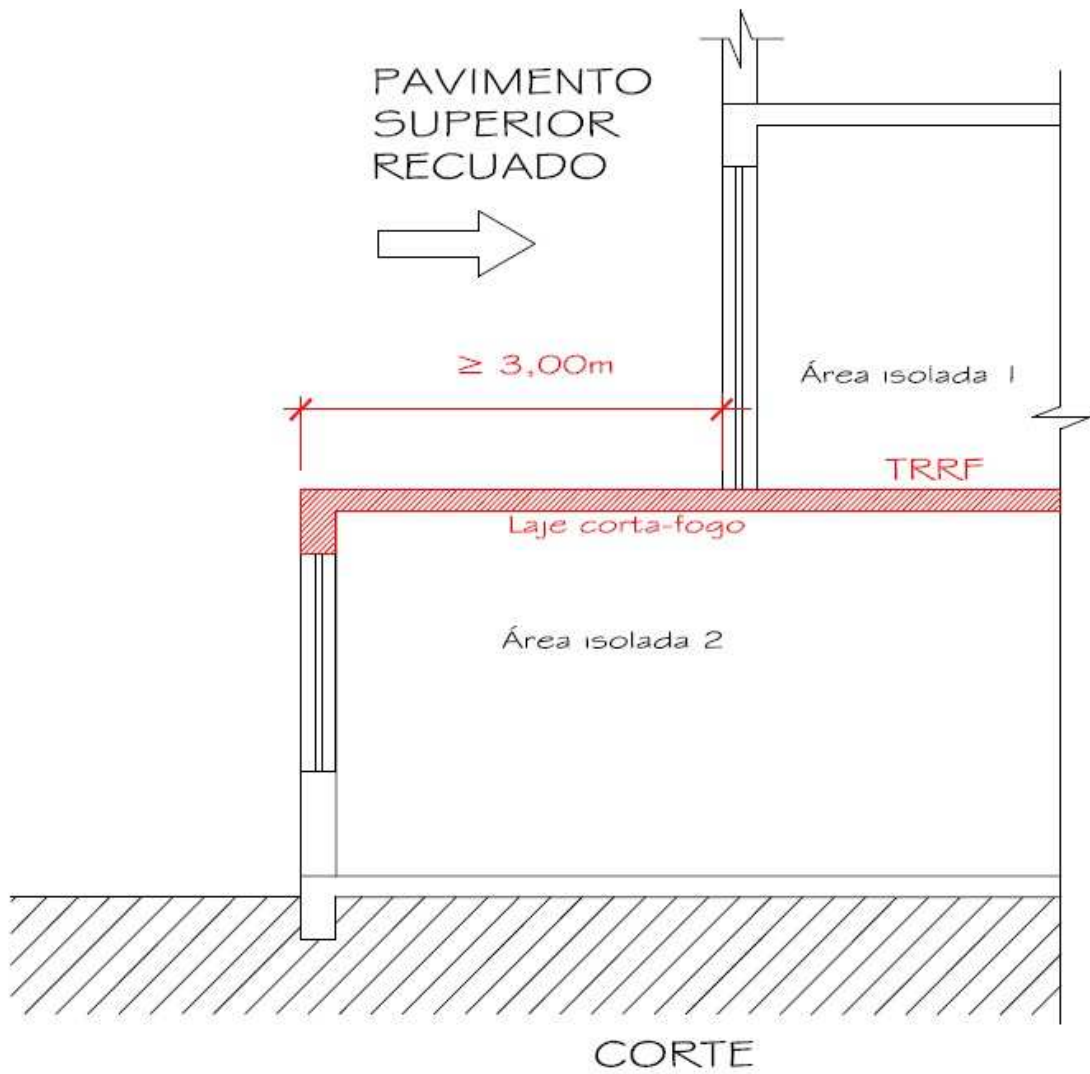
Recuo mínimo de 3 m entre pavimentos aislados
